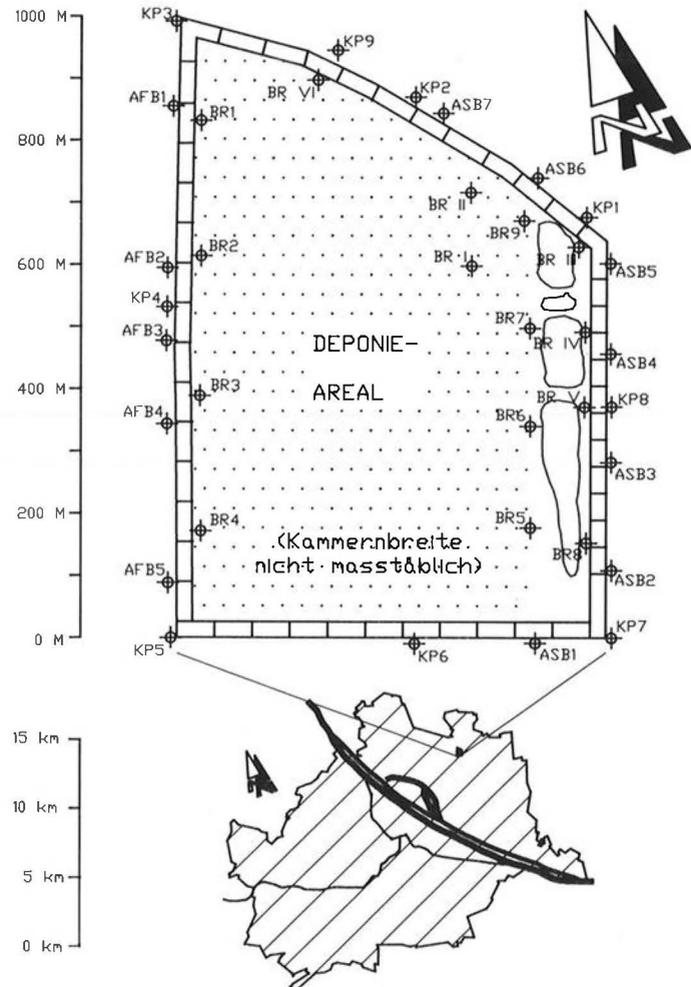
Lageplan der Deponie mit Situierung innerhalb des Stadtgebietes von Wien
